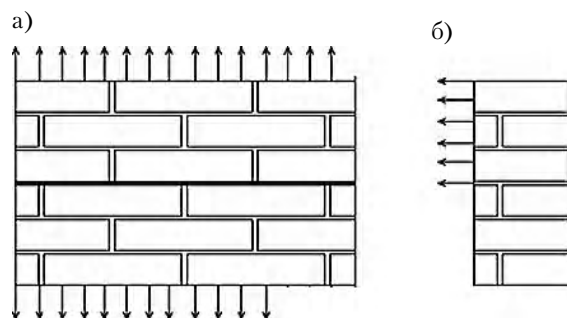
Виды сцепления между раствором и камнем при работе кладки на растяжение: а) нормальное; б) касательное.
